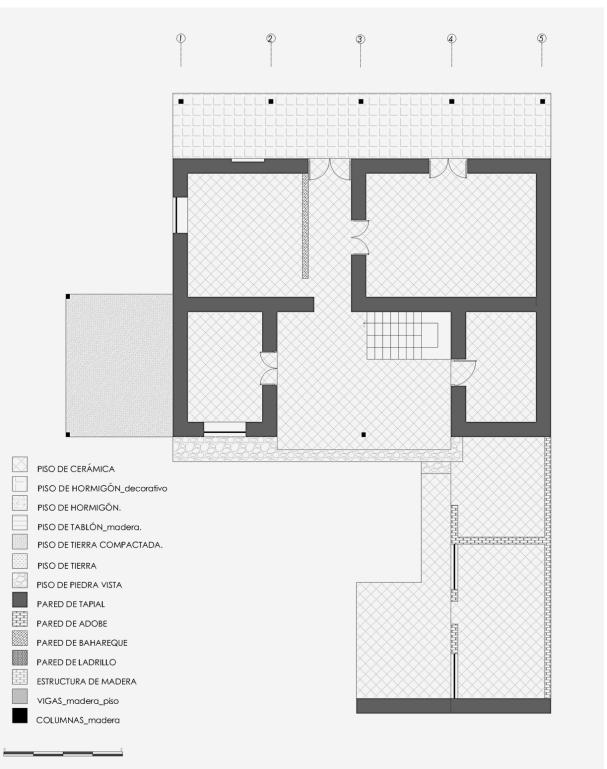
Planta arquitectónica (2º), vivienda de un poblador extranjero 002
